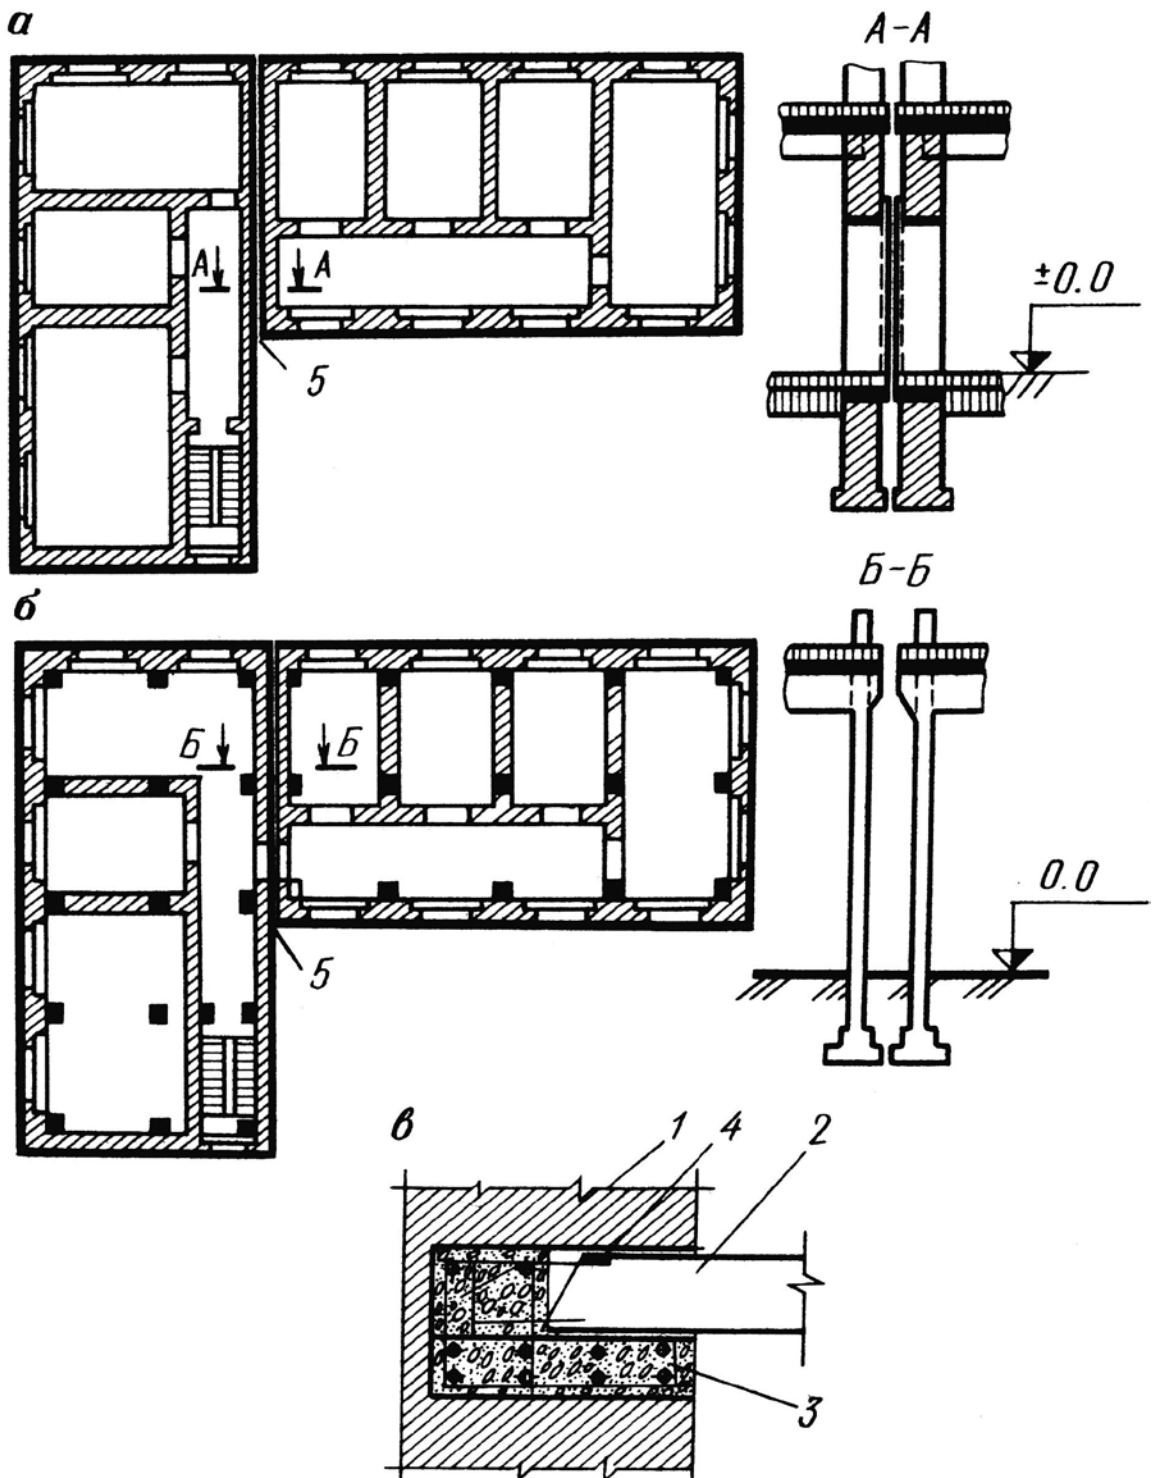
Схемы разрезки зданий на отсеки антисейсмическими швами:
